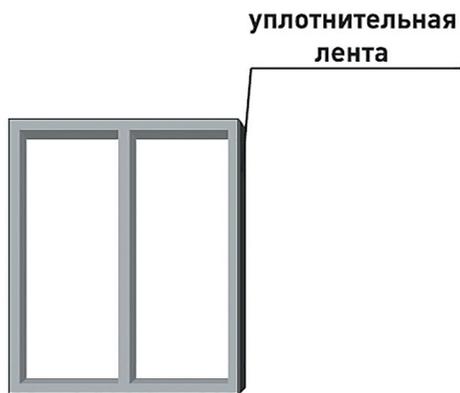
Приклейка и схема расположения уплотнительной ленты в каркасе
